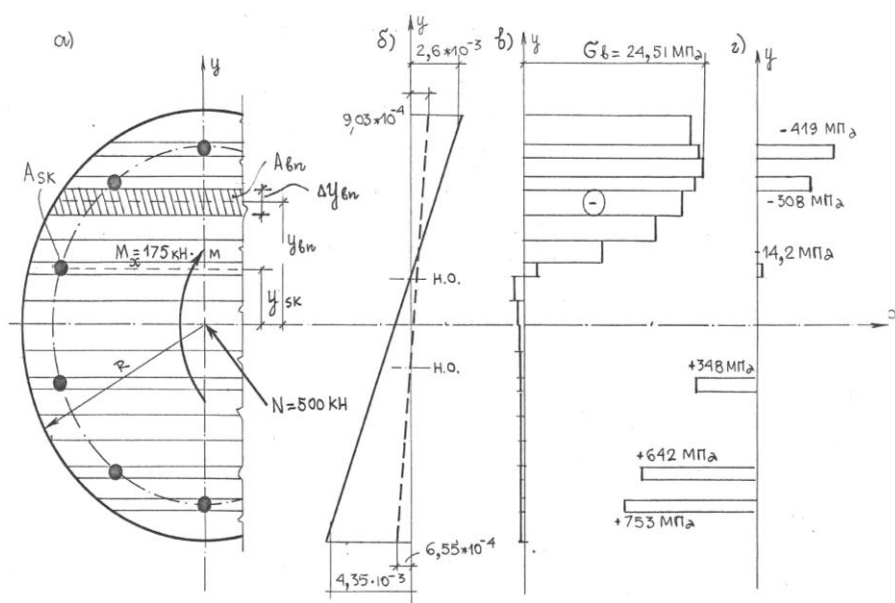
Сечение круглой формы с высокопрочной арматурой: а) схема разбивки, б) напряжения в бетоне, г) напряжения в арматуре, продольные деформации по сечению
